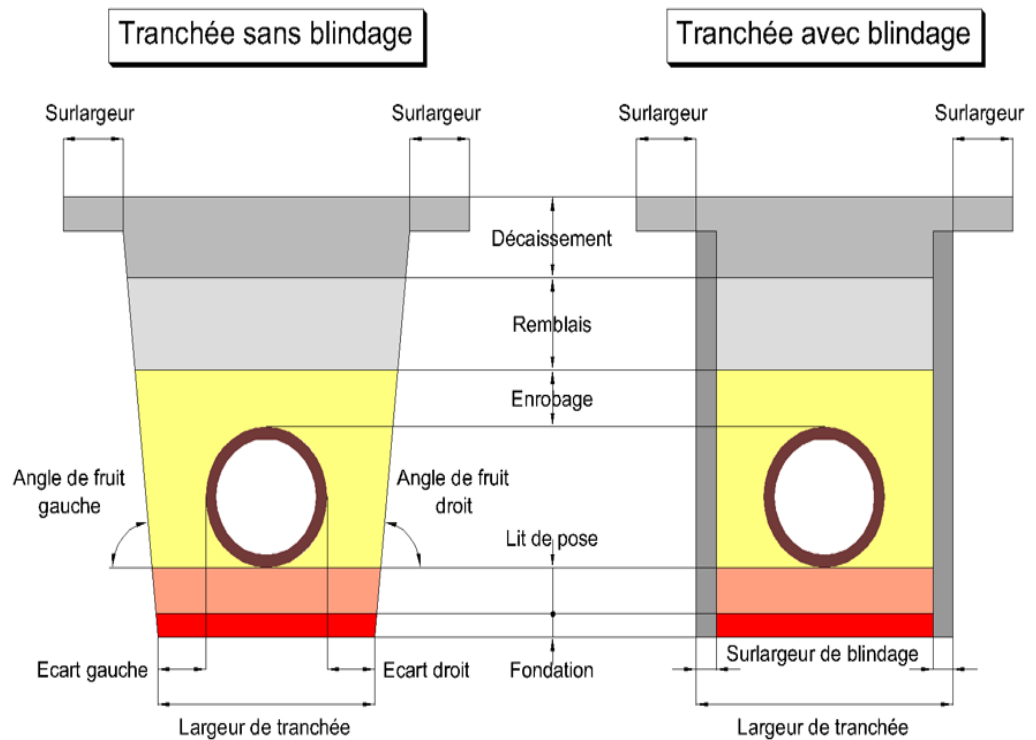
Coupe transversale d'une tranchée avec la mise en place de la conduite
